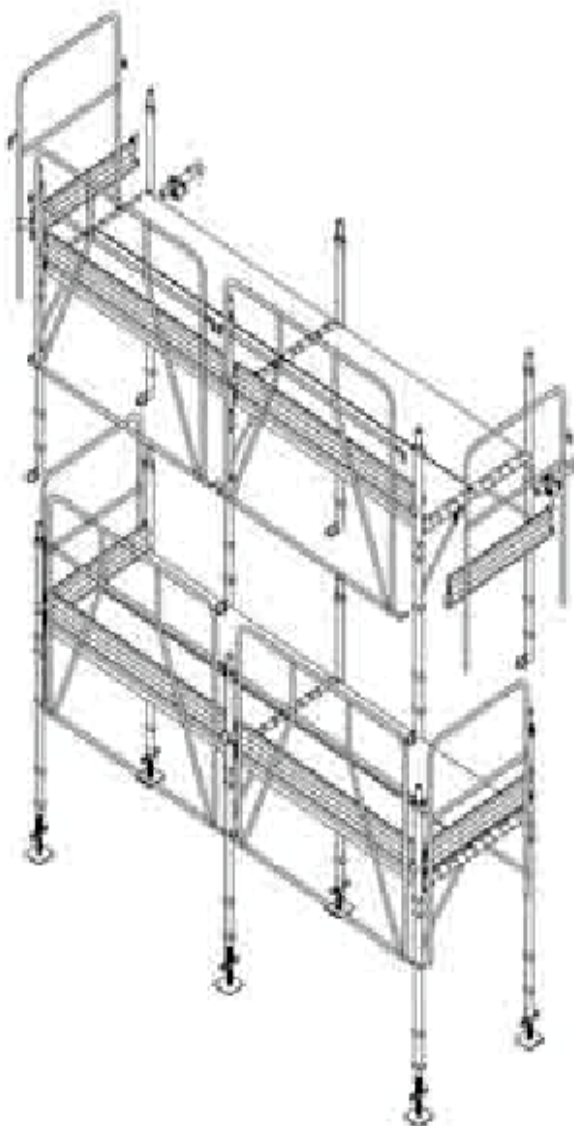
Esempio di ponteggi a telai con parapetto di protezione collettiva
